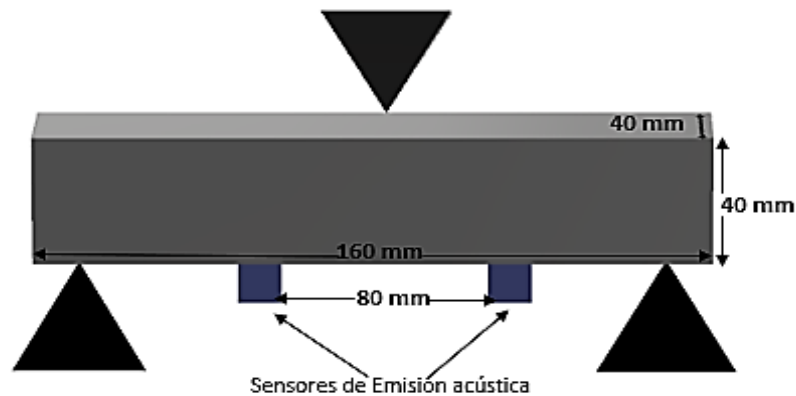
Esquema de las muestras del mortero a compresión.
